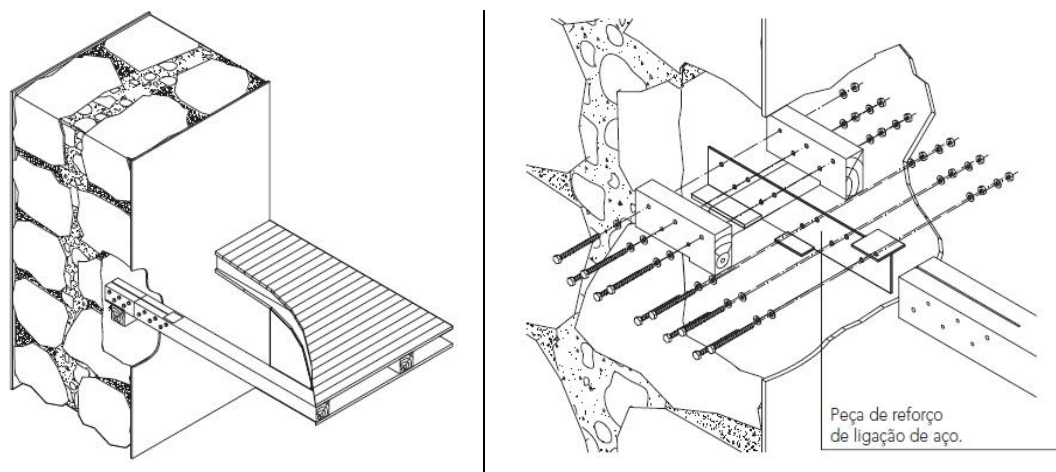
Introdução de elementos metálicos no interior da viga (Cóias [6])
